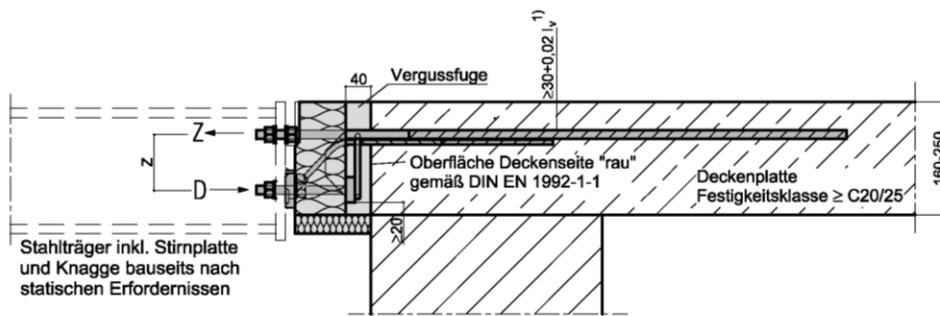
Schöck Isokorb Typ RKS10 und RKS14
